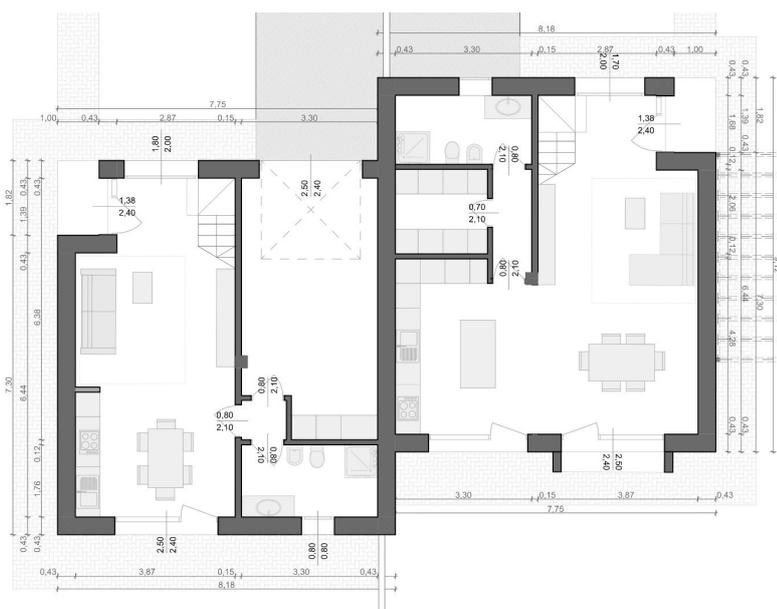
Pianta piano terra, rappresentante la disposizione degli spazi, elaborato fornito da “Officina23”.
